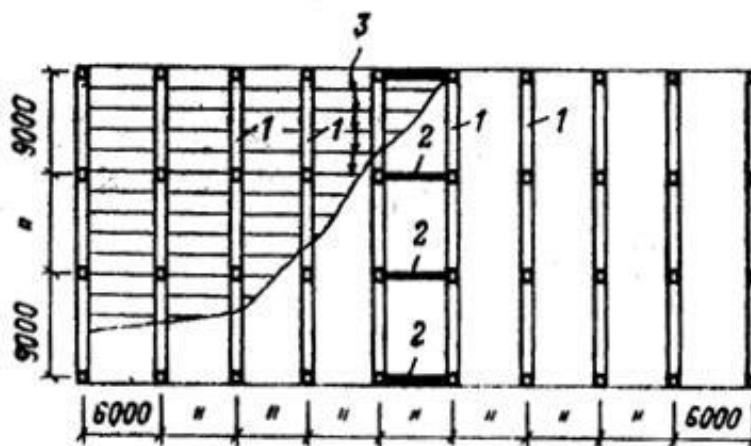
Конструктивный план многоэтажного каркаса промышленного здания
